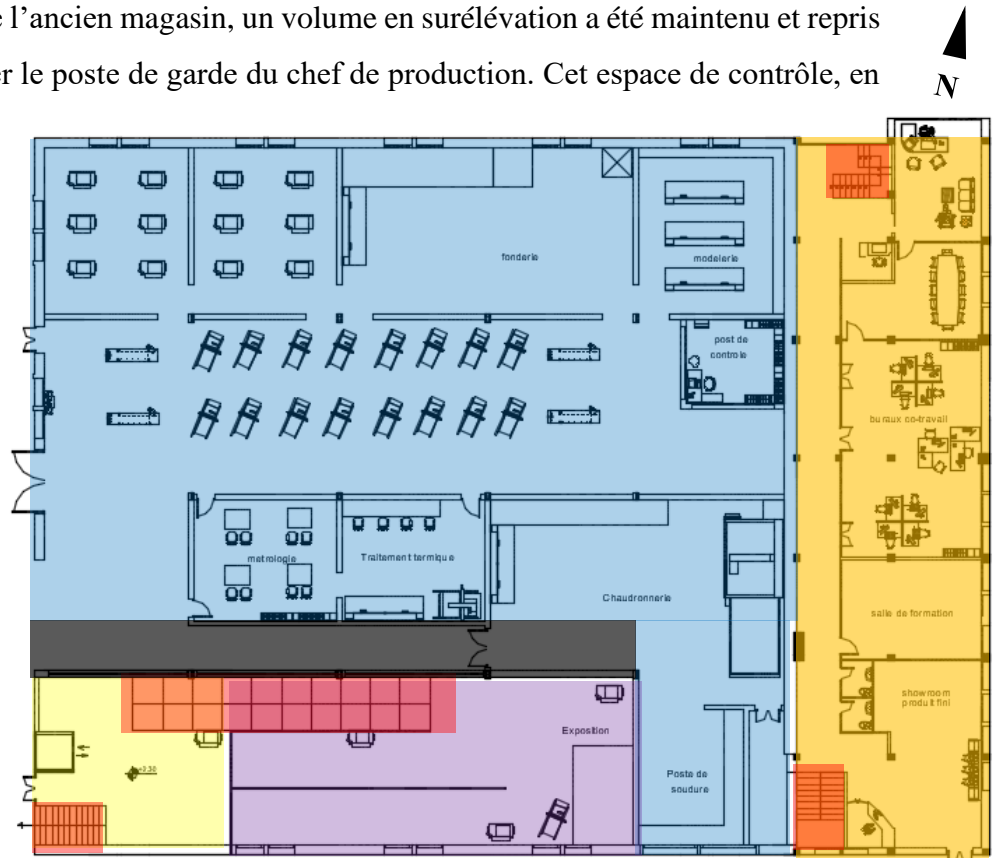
Plan de l'étage du bâtiment principal – Source : Auteur
